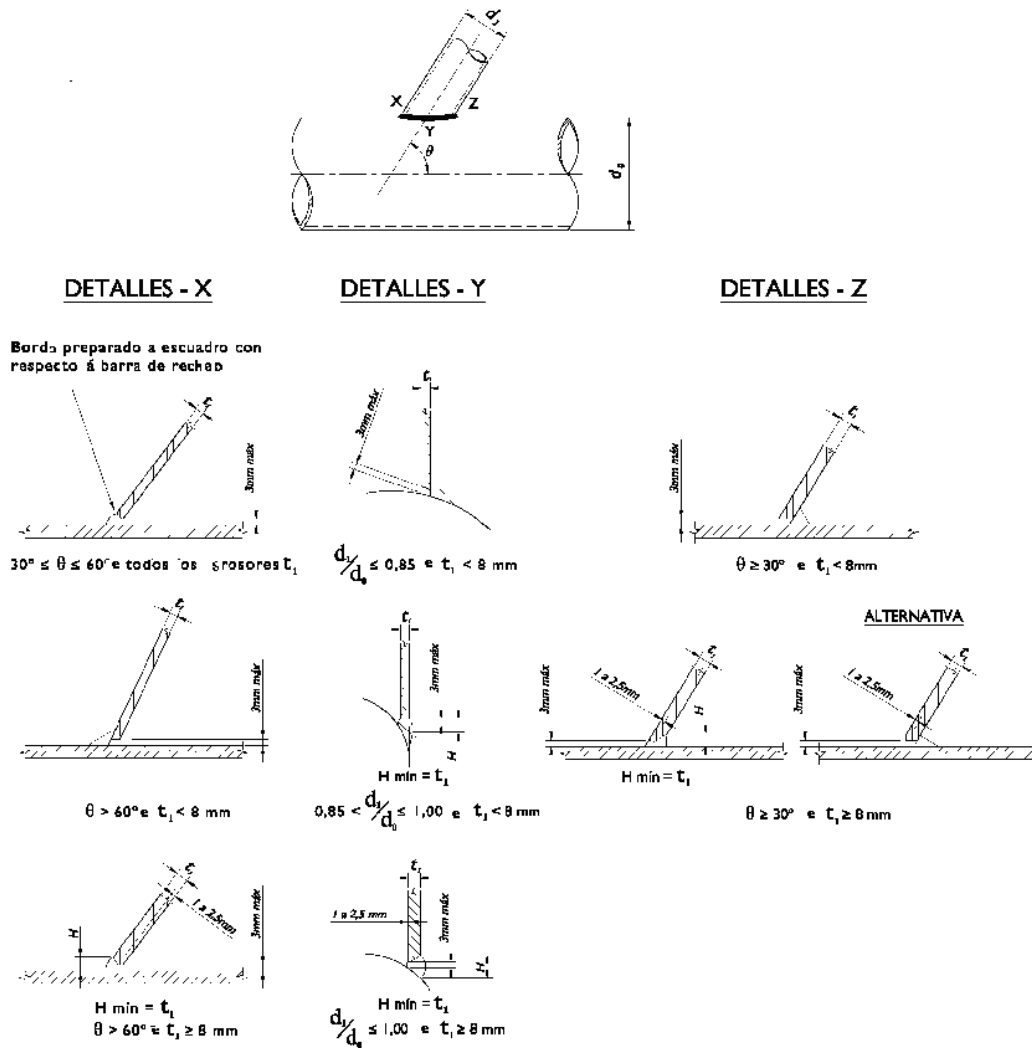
c. Detalles constructivos para soldaduras tipo para perfís tubulares circulares
